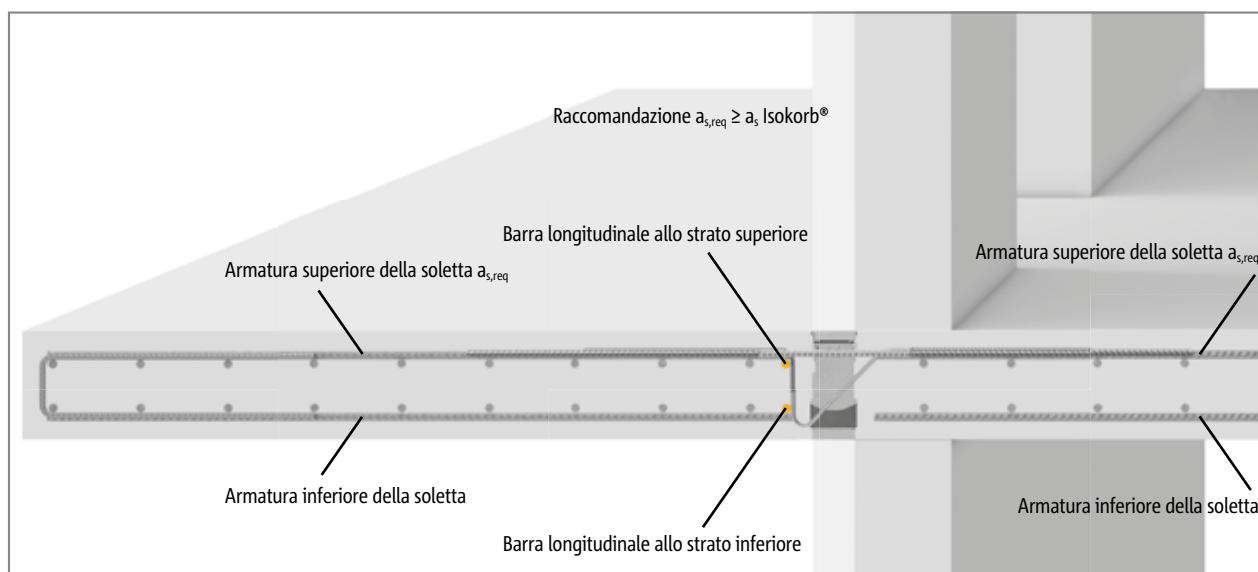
Schöck Isokorb® tipo K, armatura in opera nel caso di appoggio diretto
